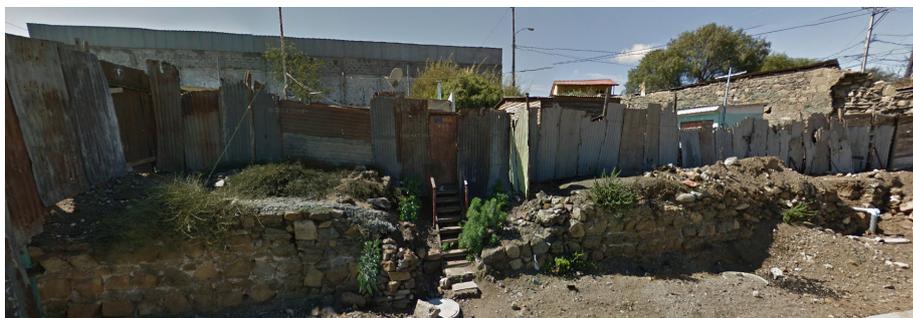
Muros de mampostería de piedra que conformaban los hornos de reverbero.
